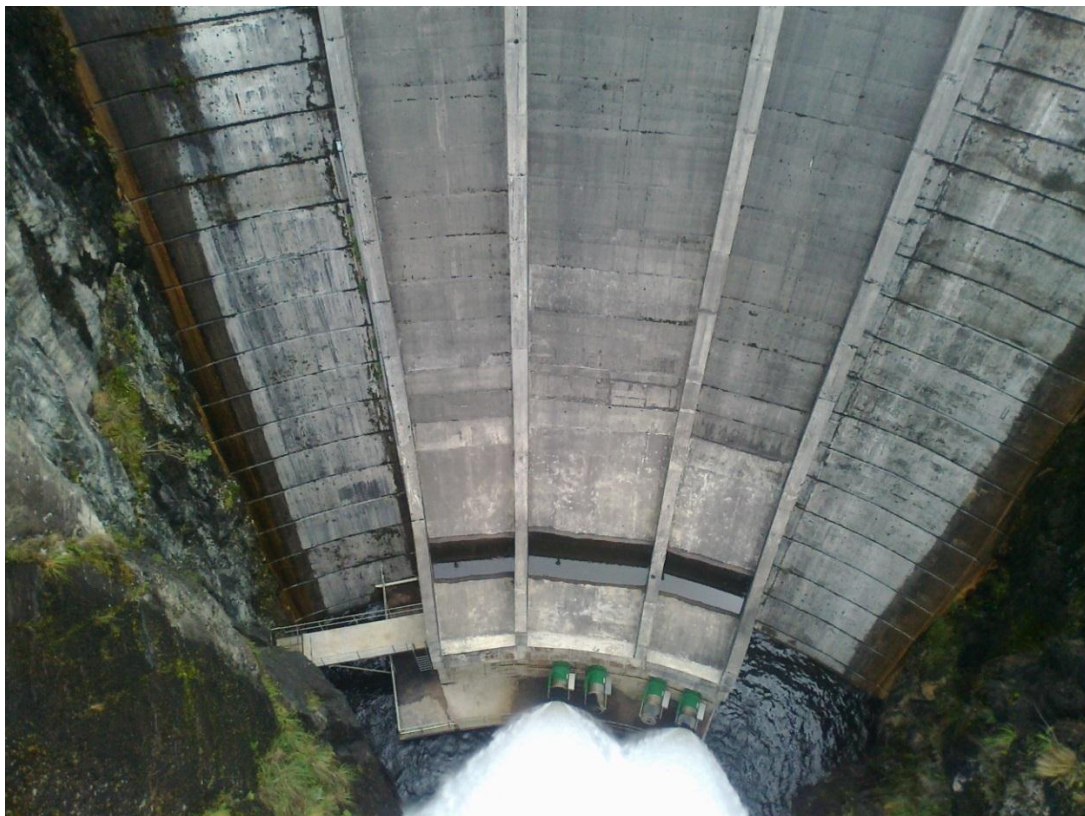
Válvulas de desagüe de fondo a pie de la Presa Chanlud
